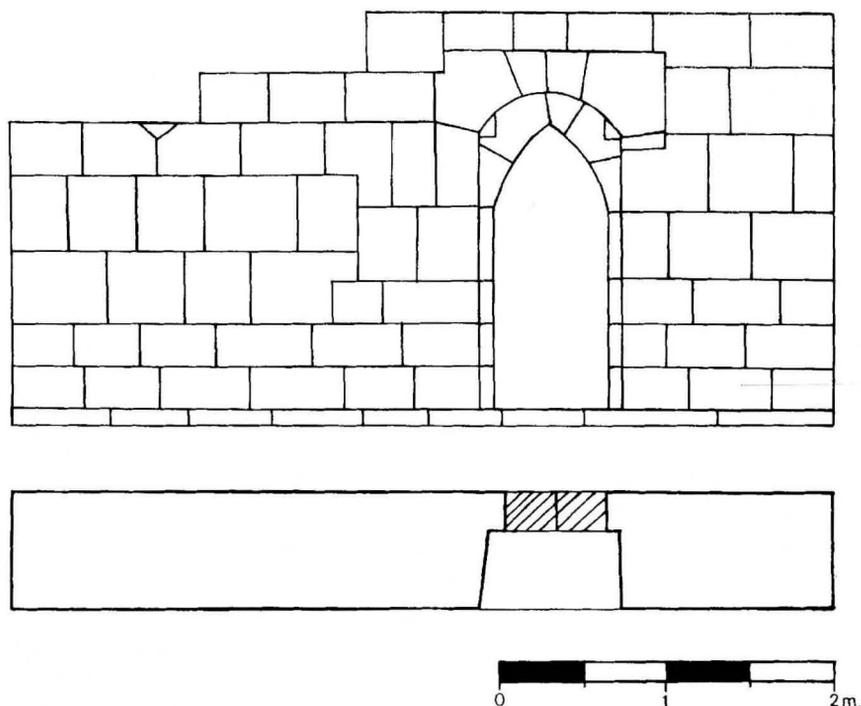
Planta y alzado de la puerta sobre la capilla de San Miguel (según E. Carrero).
